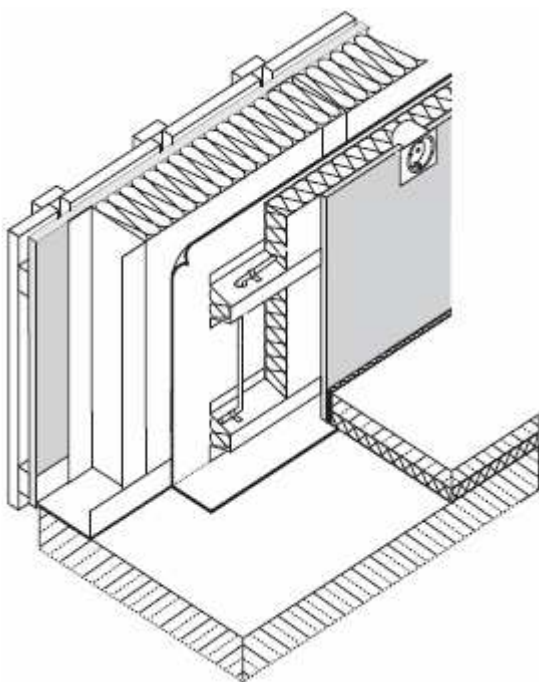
(слева): Сечение стеновой панели с 2-мя слоями утепления с ненарушенным слоем герметизации при устройстве электрических разводов в стене.
